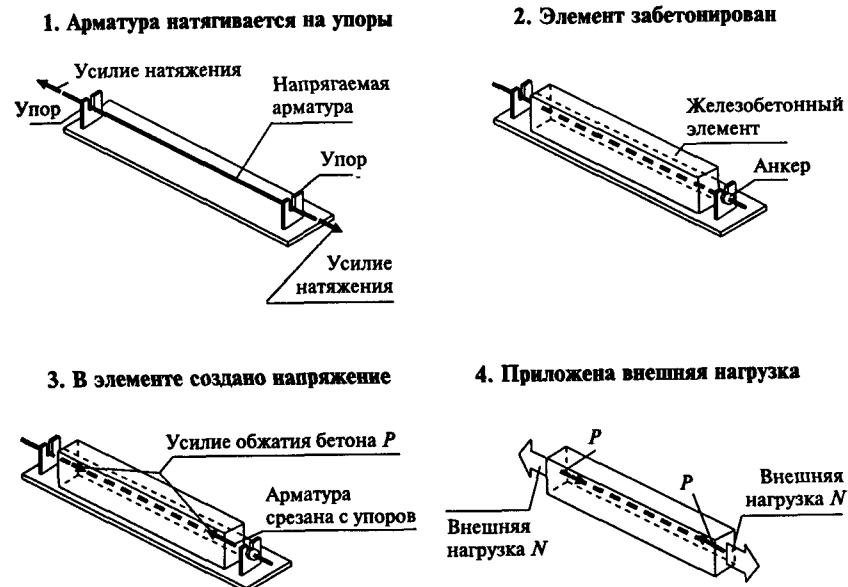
Стадии создания и работы предварительно напряженного растянутого элемента с натяжением арматуры на упоры
